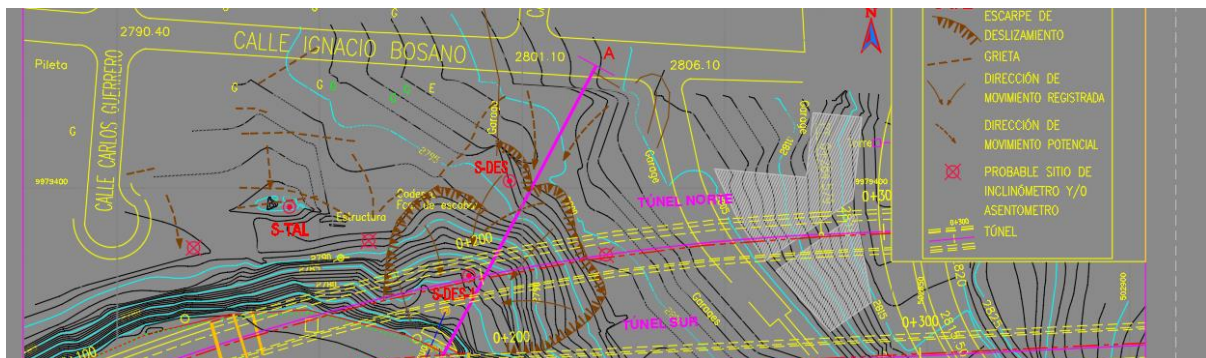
Planta Ubicación deslizamiento Activo entrada de Túnel Fuente ASTEC
